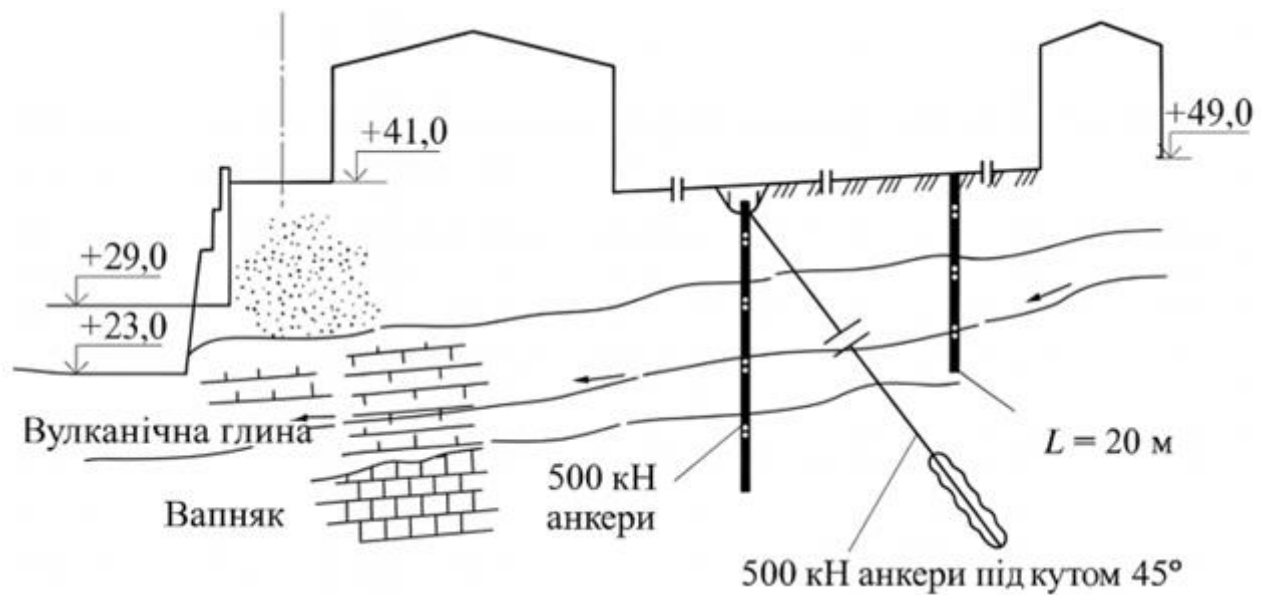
Схема заходів щодо стабілізації активізованого котлованом зсуву в Лісабоні
